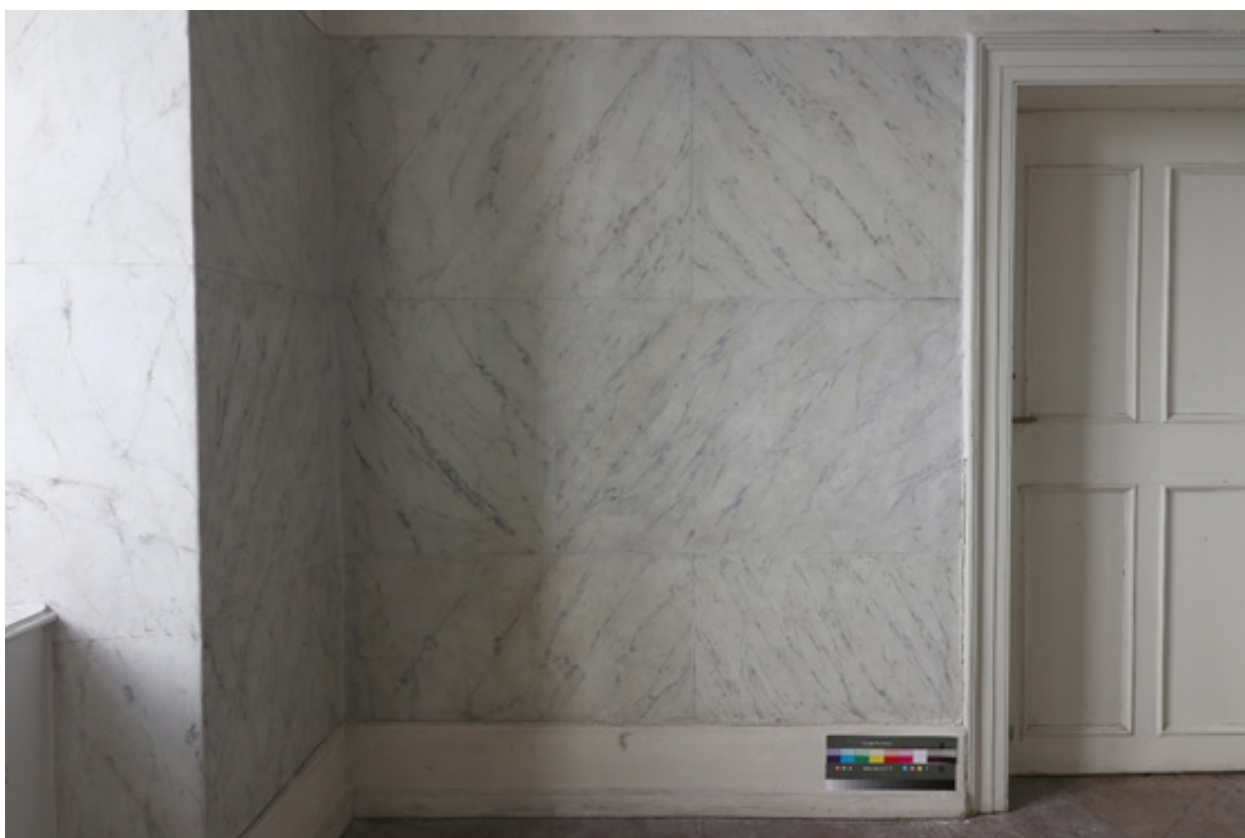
Pohled na jižní okenní špaletu východní stěny. Stav po restaurování.
